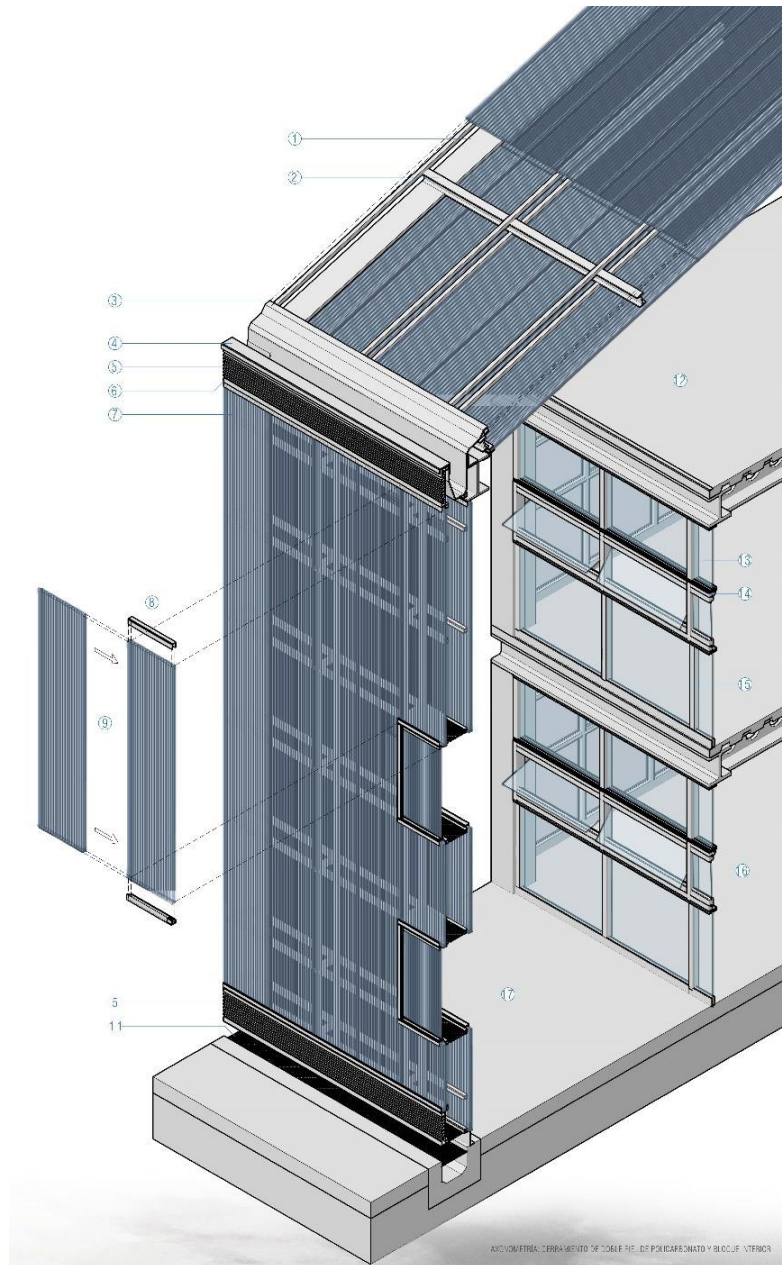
Axonometría constructiva y detalles - Propuesta arquitectónica.
